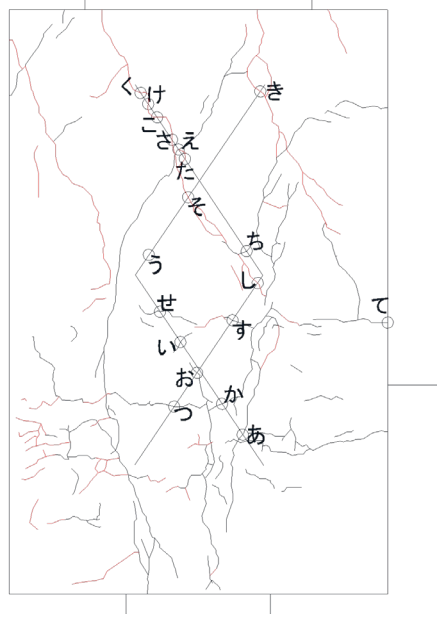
パイルキャップひび割れ幅測定位置 (試験体 D-1 正載荷)
